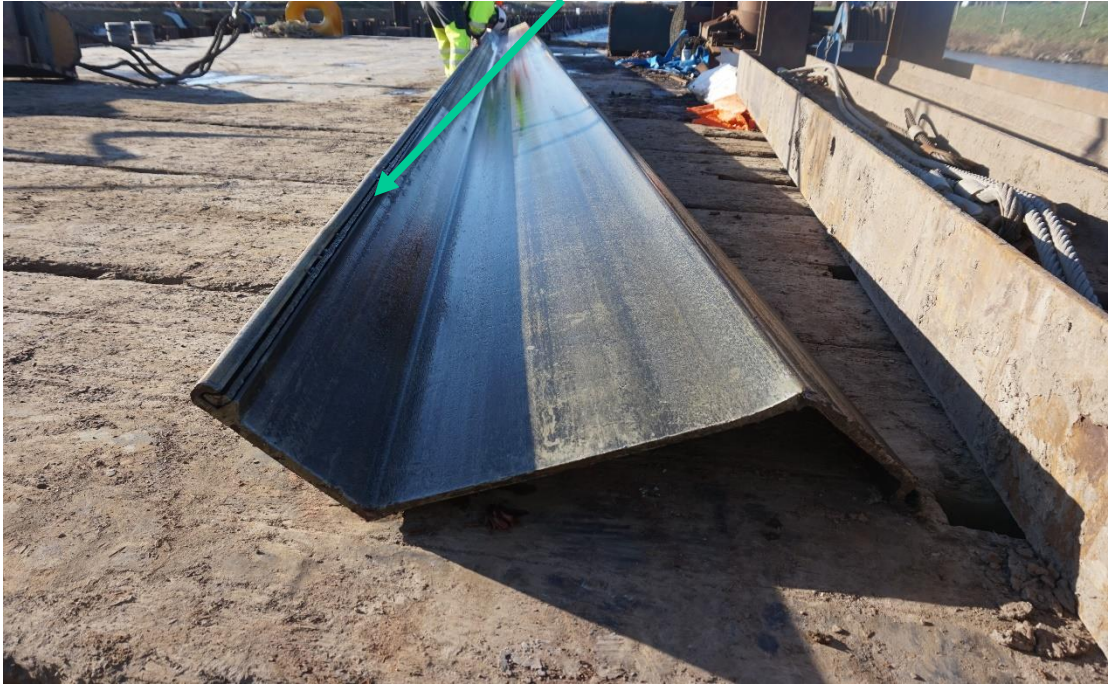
Plank 175A aan de zijde van 175 B.
